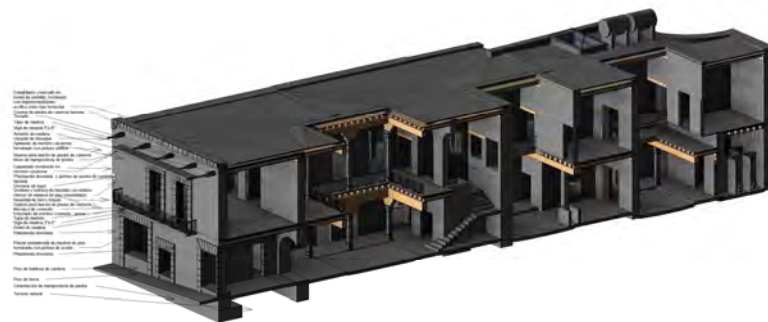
Isométrico constructivo de la CAMEM en donde se pueden observar gráficamente las diferentes partidas en las que fue dividido el inmueble para su análisis. Plano CAMEM MSC 108 Materiales y Sistemas Constructivos. Elaboró: METR
